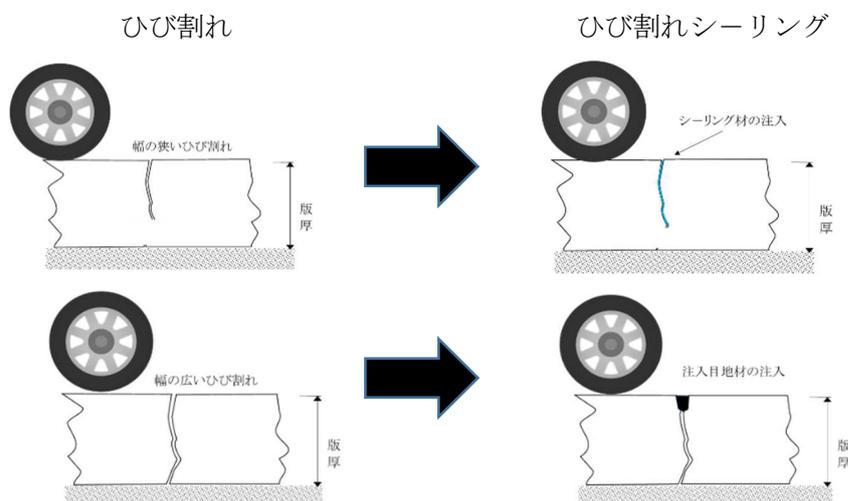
ひび割れとひび割れシーリング工法
